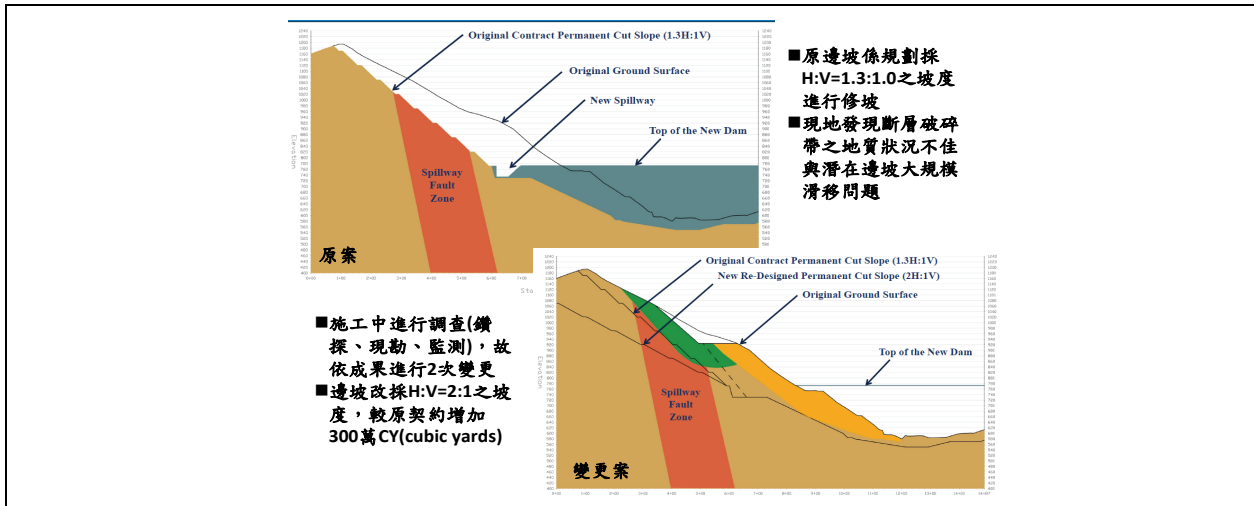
Calaveras Dam 左岸邊坡施工變更示意
